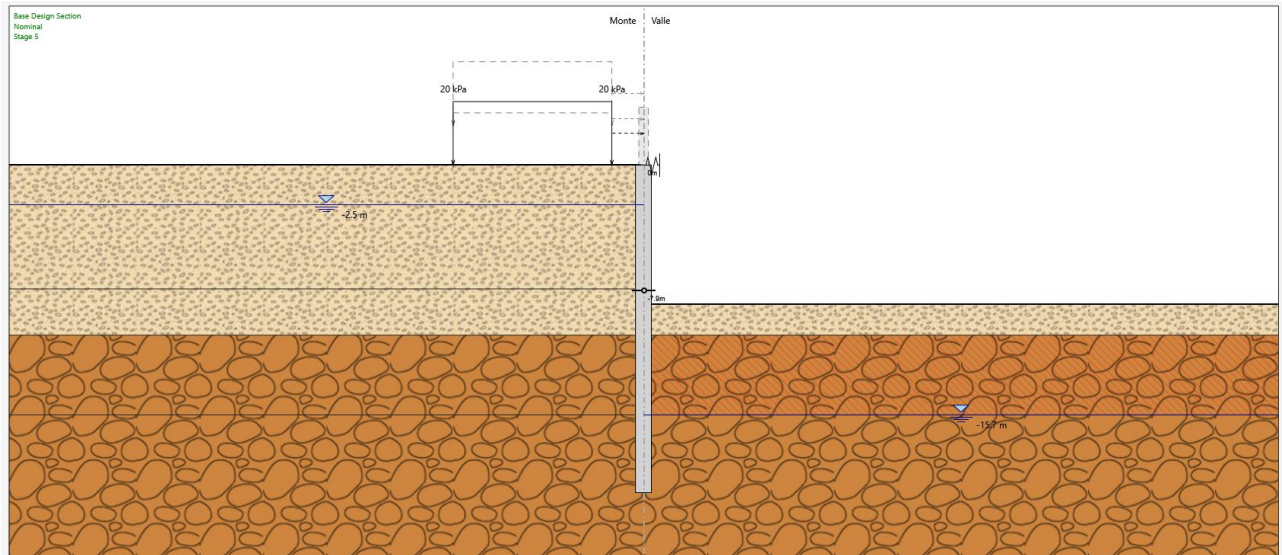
Realizzazione della fondazione attraverso un vincolo fisso
